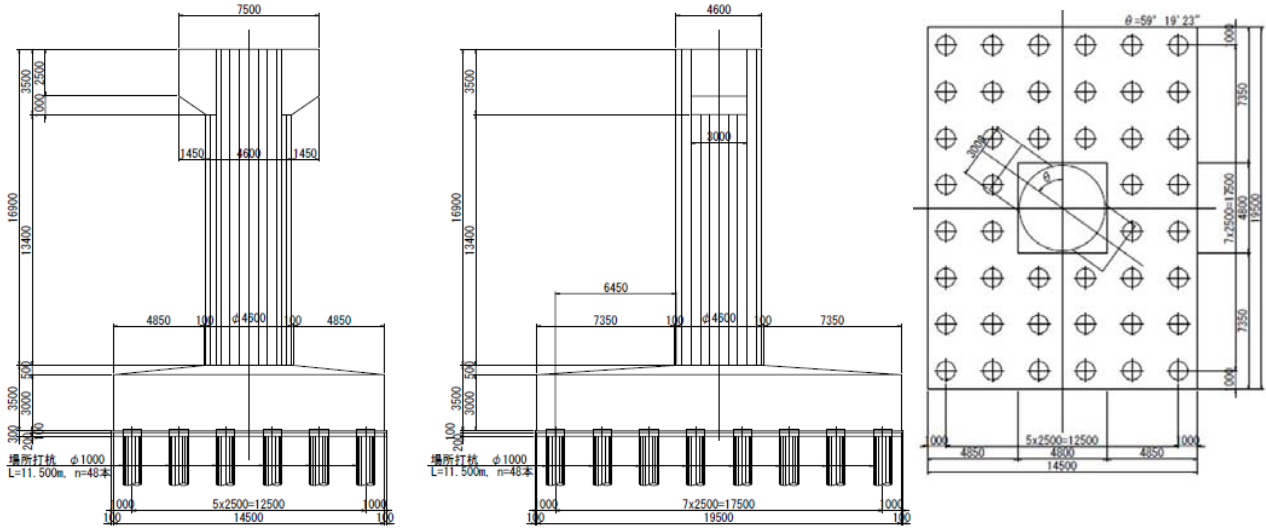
実験対象下部構造一般図 正面図（左）側面図（中央）平面図（右）（単位：mm）
